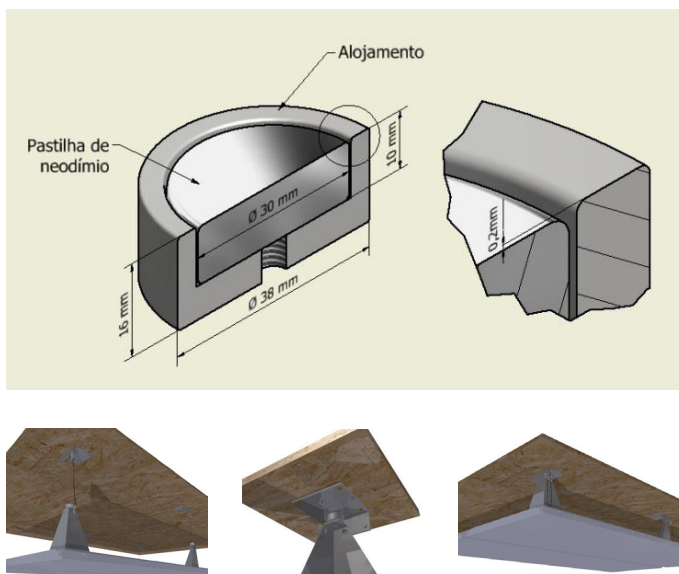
Dispositivos de fixação do elemento de revestimento horizontal na laje de cobertura
